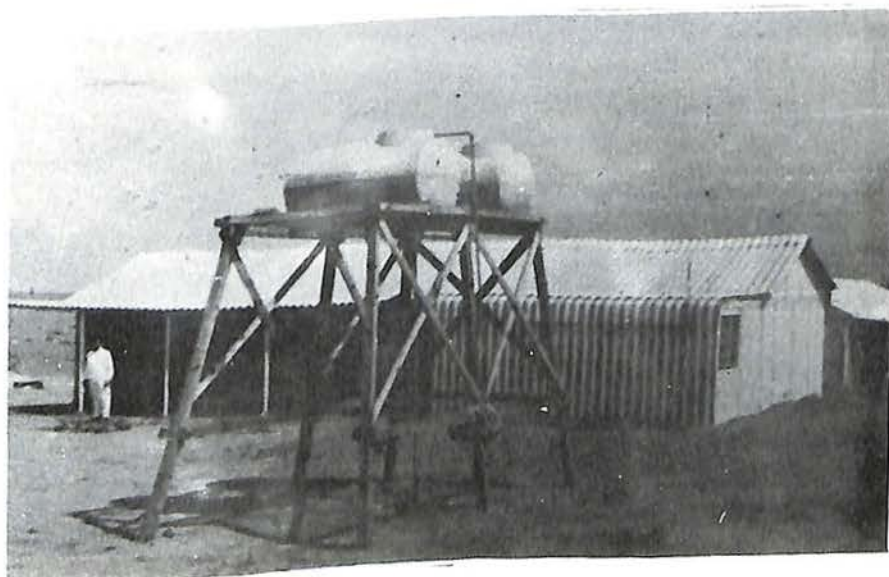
DETALLE DE LOS TINACOS Y AL FONDO LA CASA DE INGENIEROS.
